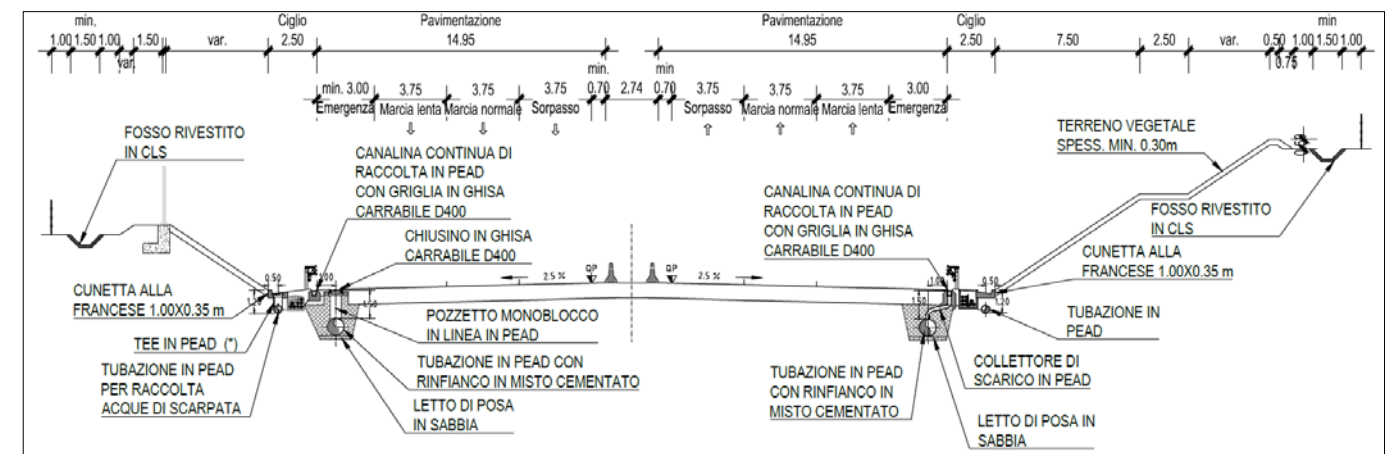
Schema di raccolta e collettamento delle acque di piattaforma nei tratti in trincea (sezione tipo).
